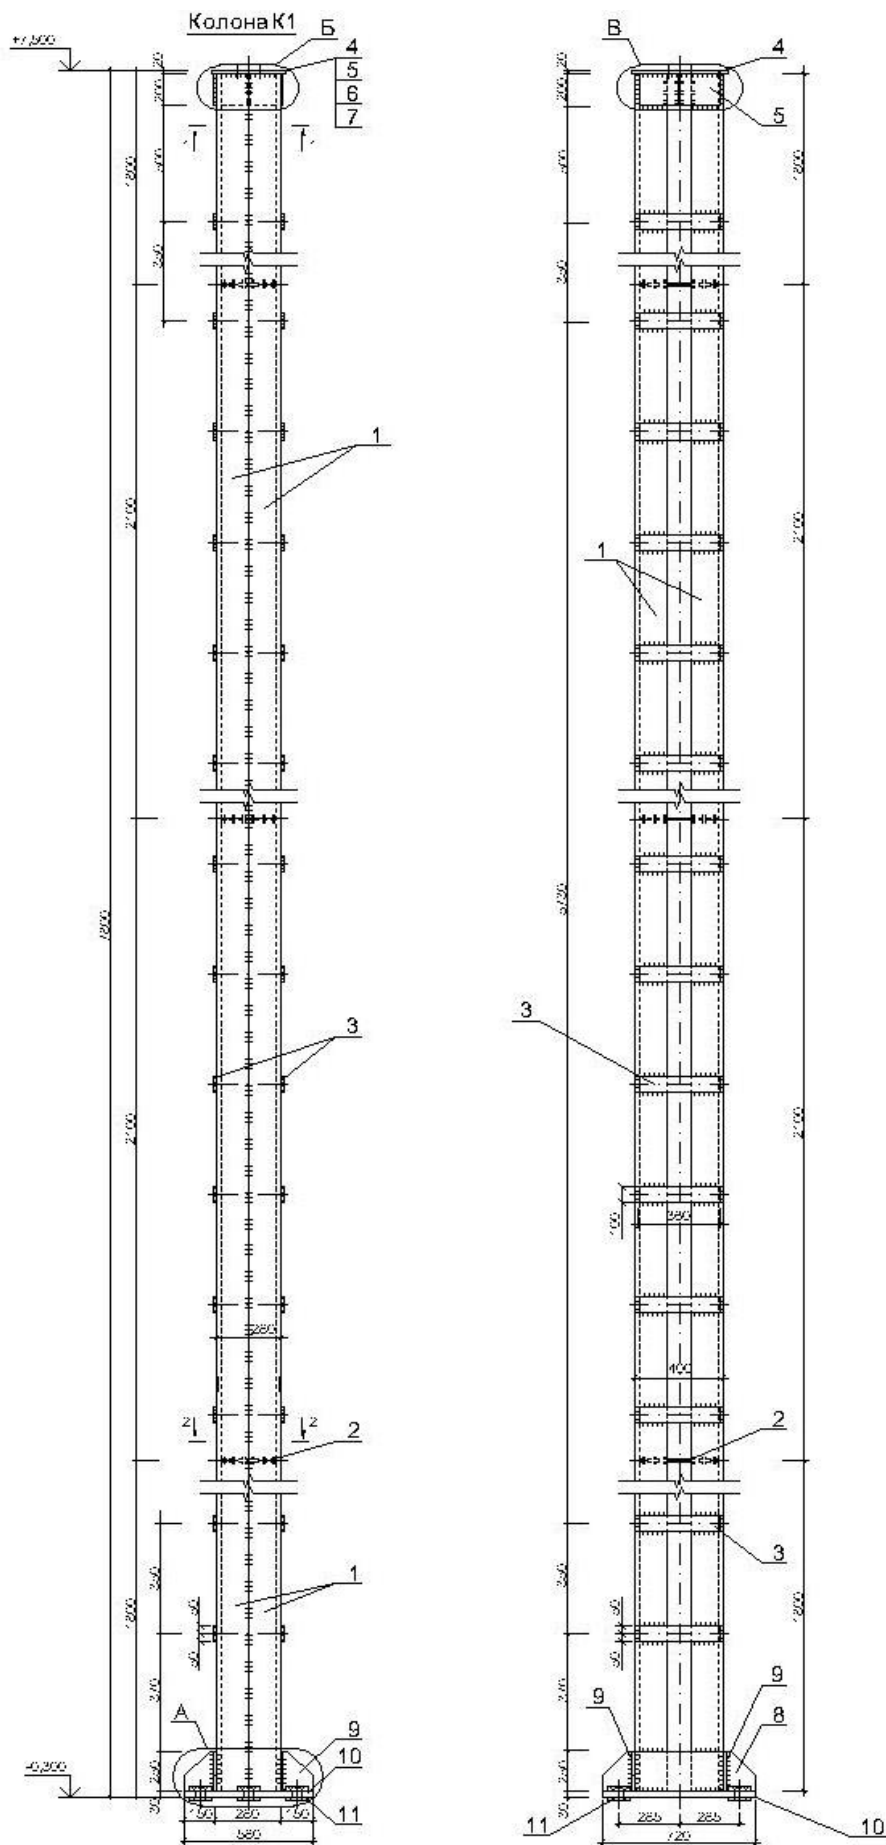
Наскрізна колона поперечної рами каркасу, що проектується.
